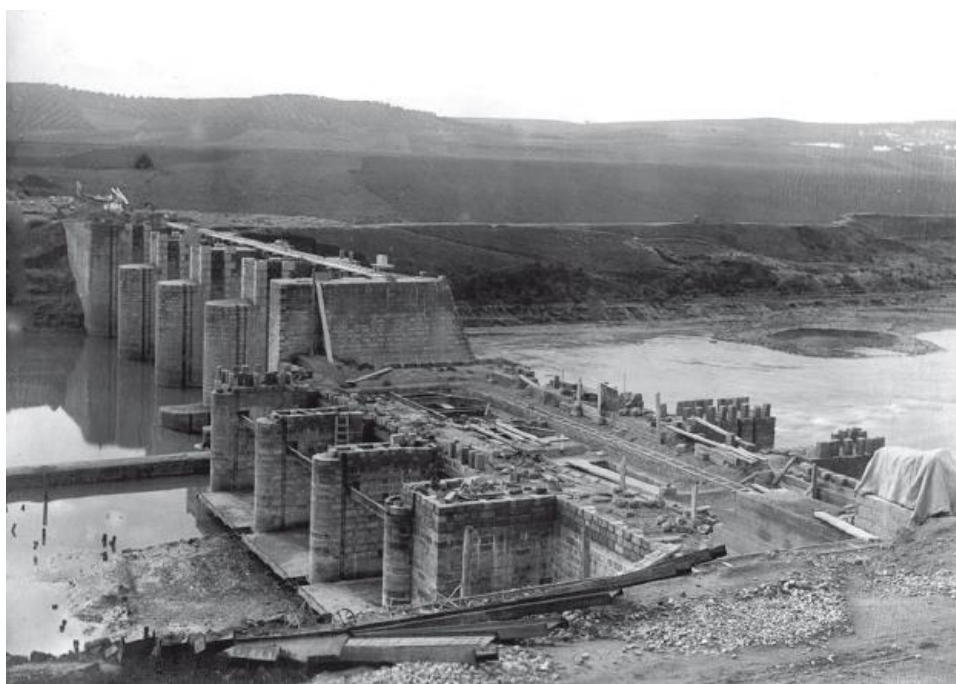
Construcción de planta de edificio de la Central (1915). Fuente: Anónimo. [44]
